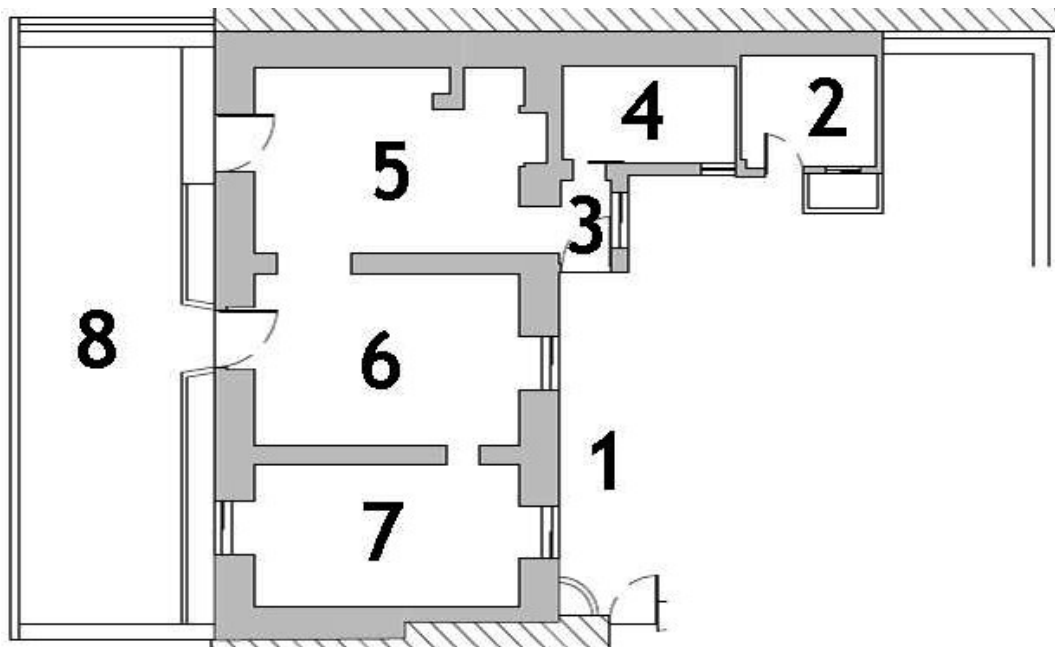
Planta inicial de zonas. Fonte: Andreia Poim
